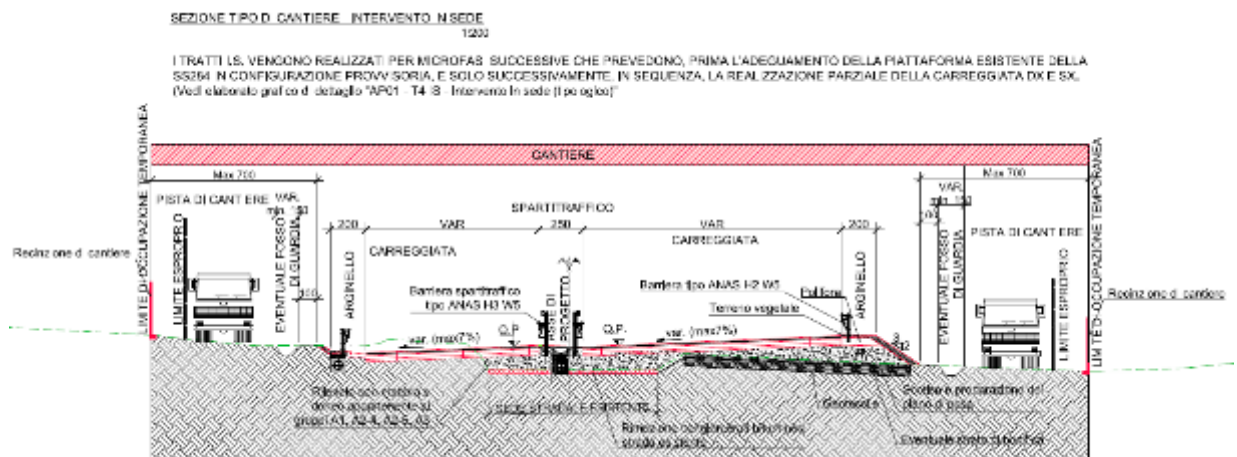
Intervento IN SEDE (I.S.) – Sezione trasversale tipologica di cantierizzazione
